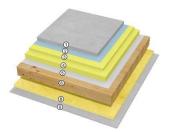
Geschossdecke Massivholz Bestand<sup>159</sup>
